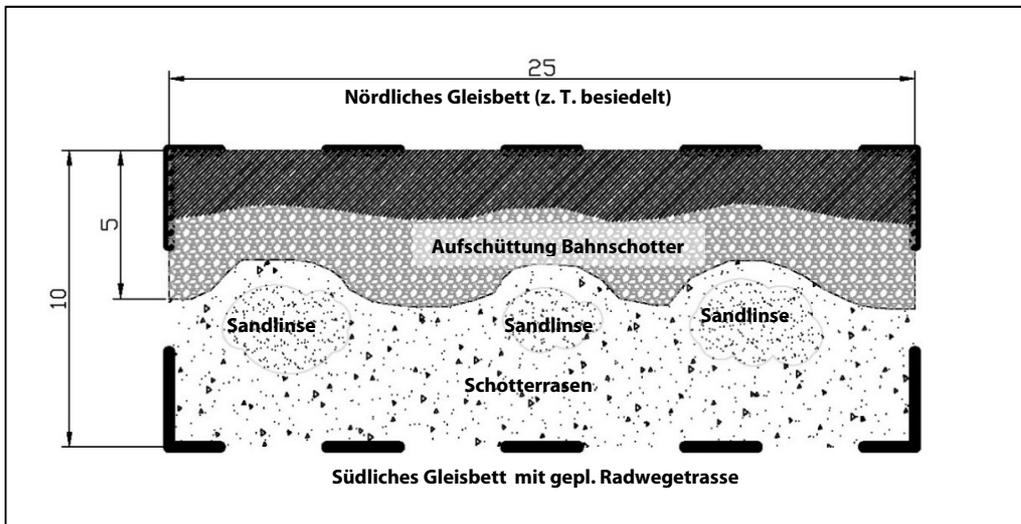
Grundriss-Schema eines Steinriegels auf Fläche A 3
